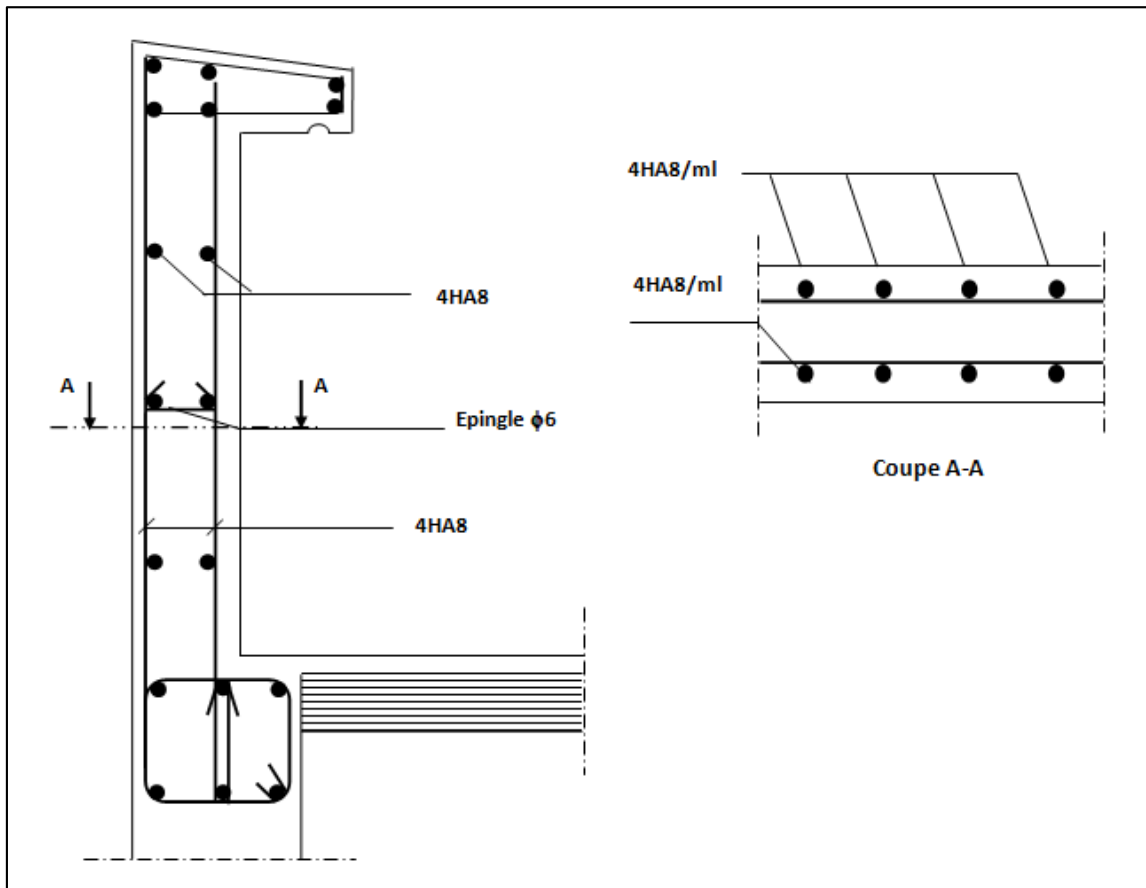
Plan de Ferrailage de l'acrotère.
